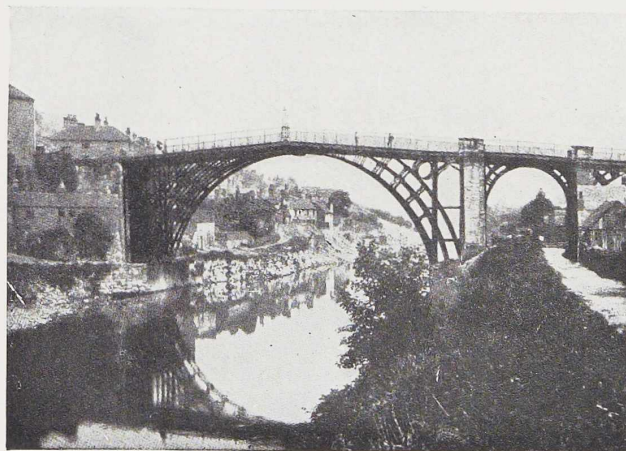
Pont en arc en fonte sur la Severn à Coalbrookdale (Grande-Bretagne) construit en 1773. L'arc central d'une hauteur de 12<sup>m</sup>80 a une portée de 30<sup>m</sup>60.
